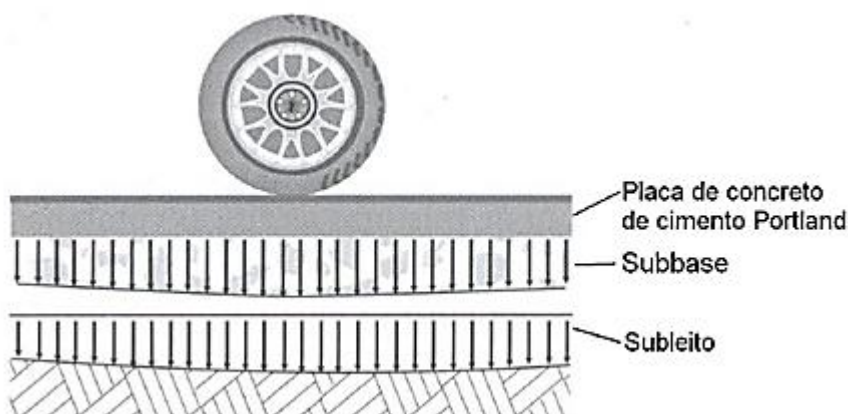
Distribuições de tensões no sub-leito em pavimentos rígidos.
